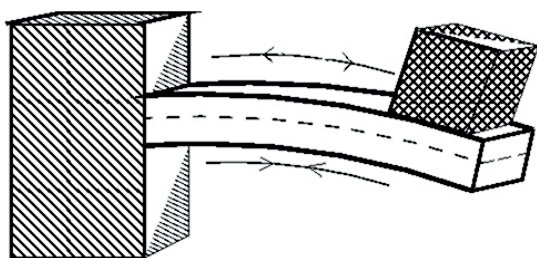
4 - “viga em balanço” ou “viga cantilever”.
